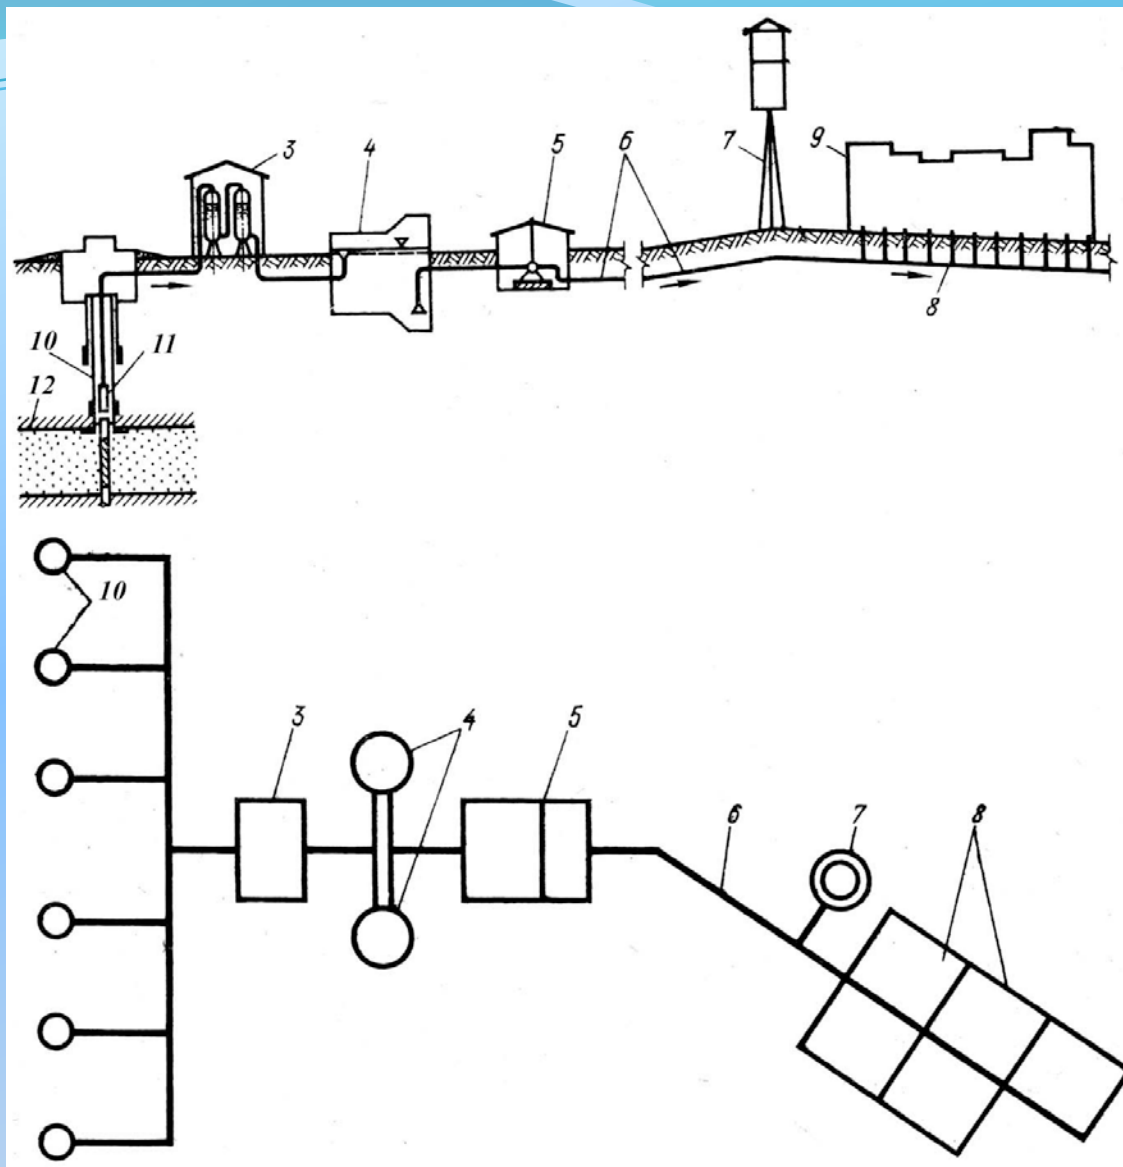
Схема водоснабжения при использовании подземных вод
